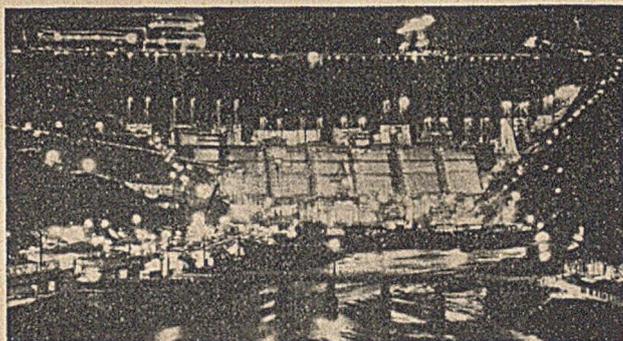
Fontana-Staumauer. Nachtarbeit mit der Betonierbrücke.
